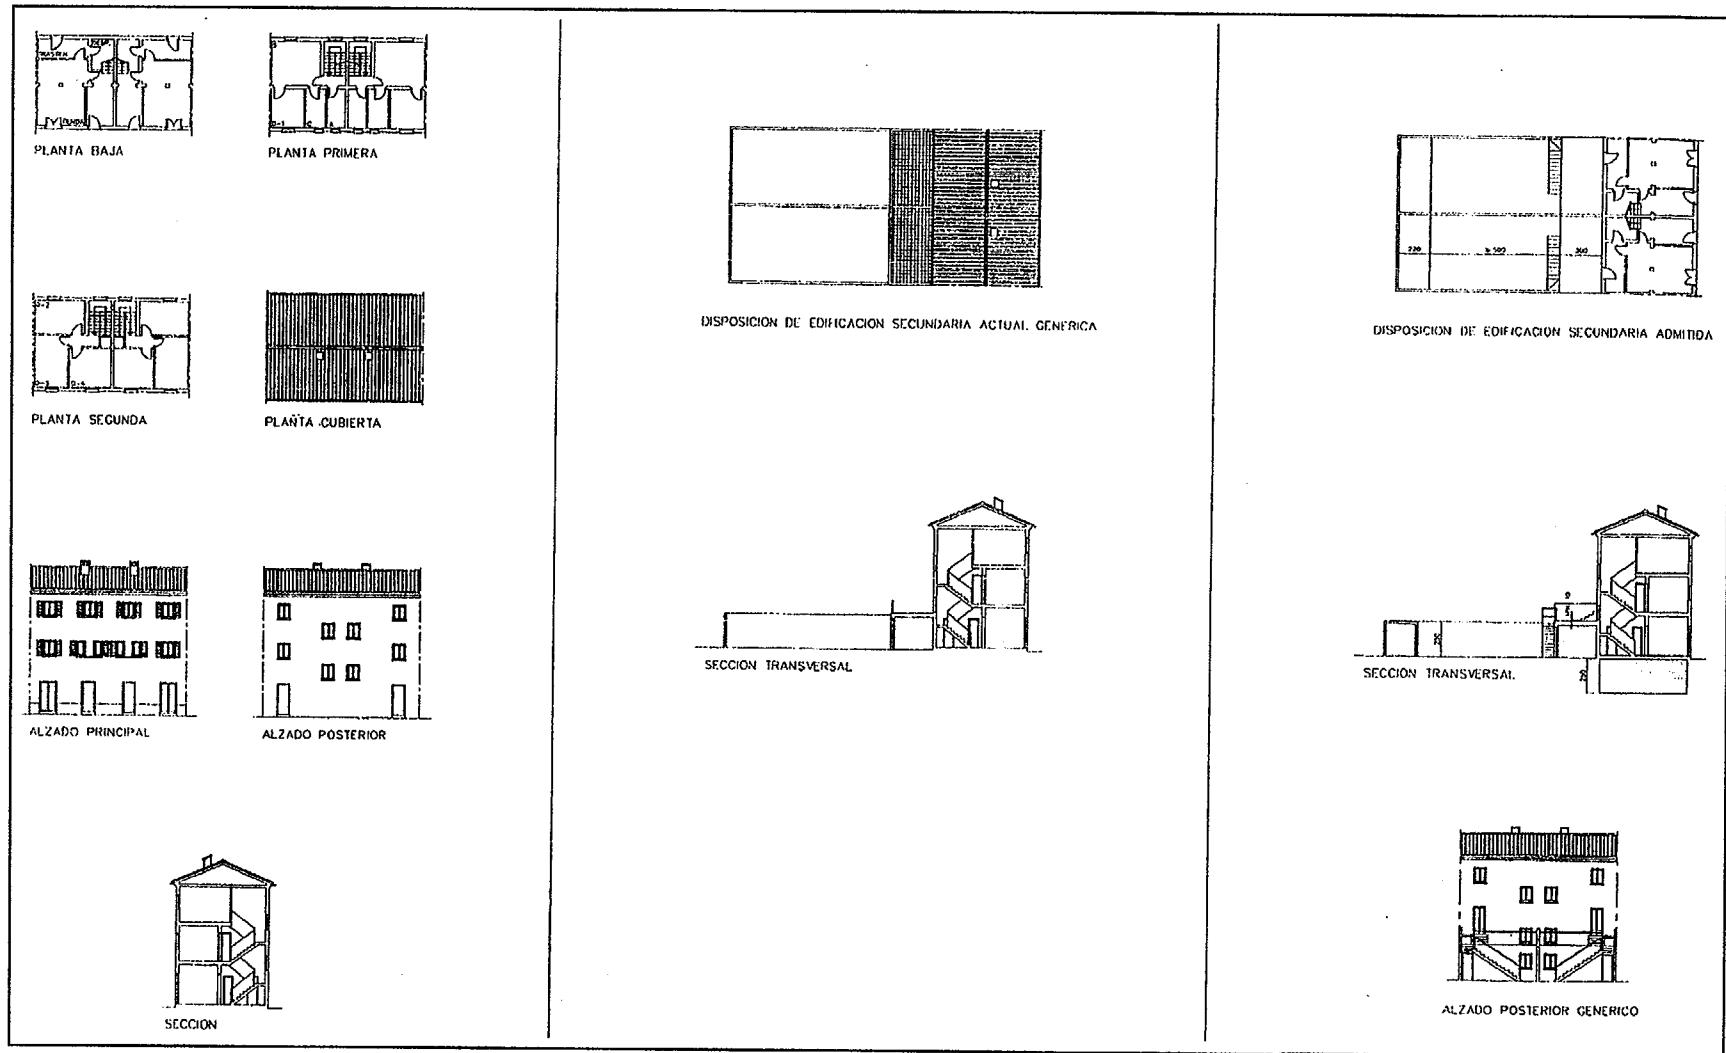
Tercio y Terol. Plantas, alzados y secciones de las viviendas del tipo G en la "Colonia" del Tercio
